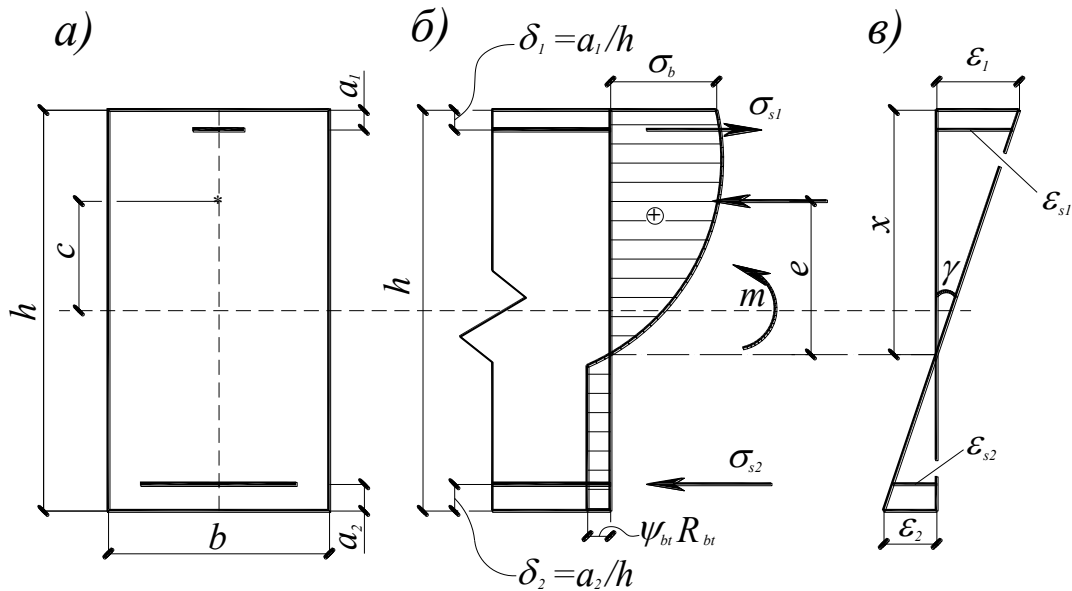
Напряженно-деформированное сечение: а – общий вид; б – эпюра усилий в сечении; в – эпюра деформаций
